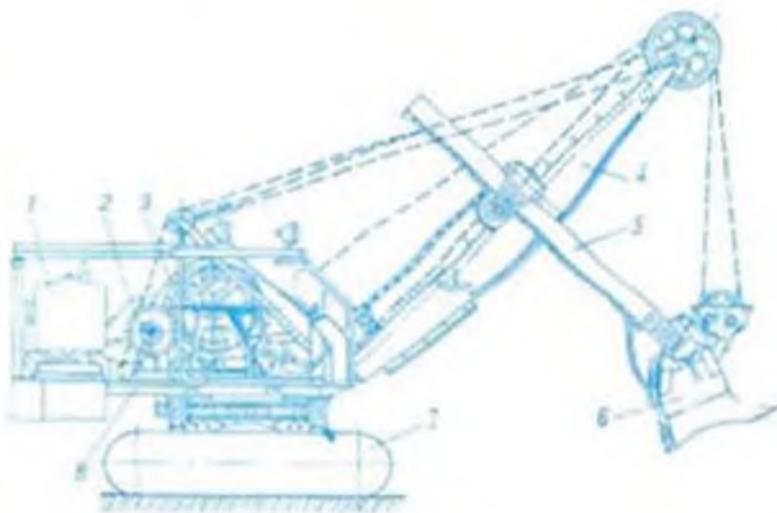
Одноковшовый экскаватор с механическим управлением Э-125216: 1 — двигатель; 2 — механизм реверса; 3 — главная лебедка; 4 — стрела; 5 — рукоятки; 6 — ковш; 7 — гусеничный ход; 8 — поворотная платформа.
